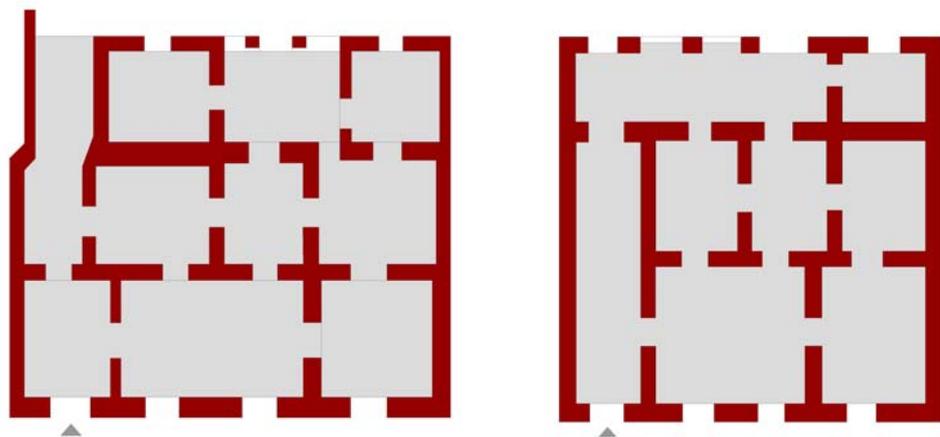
| Modelos das Plantas Tipo, Ilha de Moçambique²¹⁸
